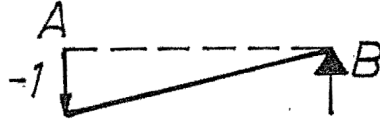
Cas d'une poutre sur deux appuis.
